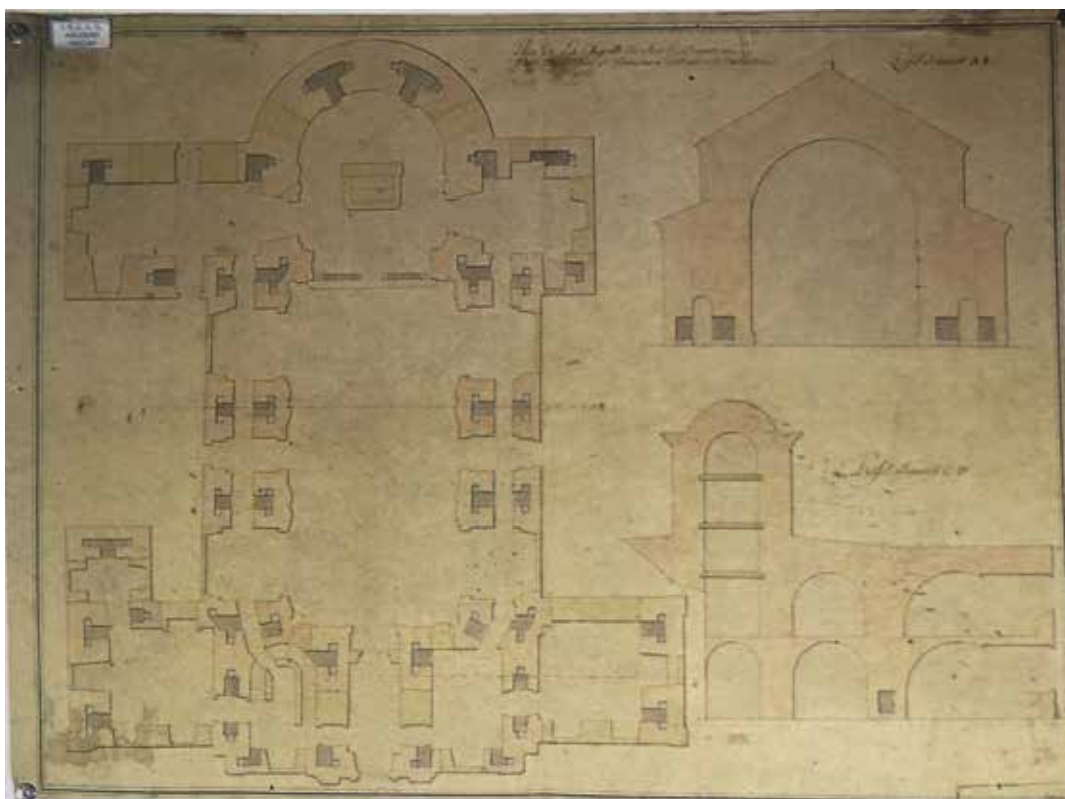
Sezione trasversale alla chiesa con particolari delle sezioni longitudinali delle nicchie trasversali alla navata, *Plan de la Chapelle du Fort la Brunette avec les dispositions de fourneaux destinée a sa destruction*, ISGAG, Brunetta, Cartella LIX A, nr. 3697
